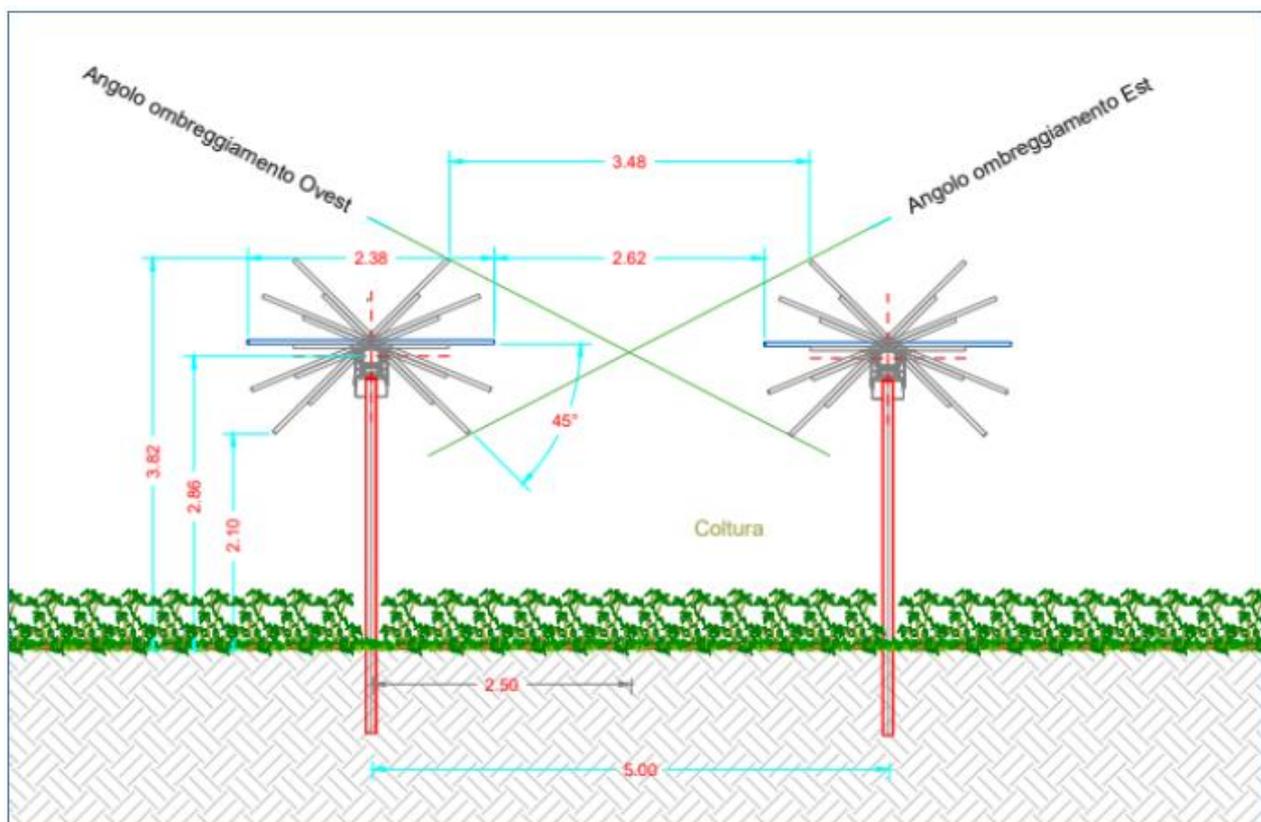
Sezione trasversale tipologica struttura Tracker con erbaio
